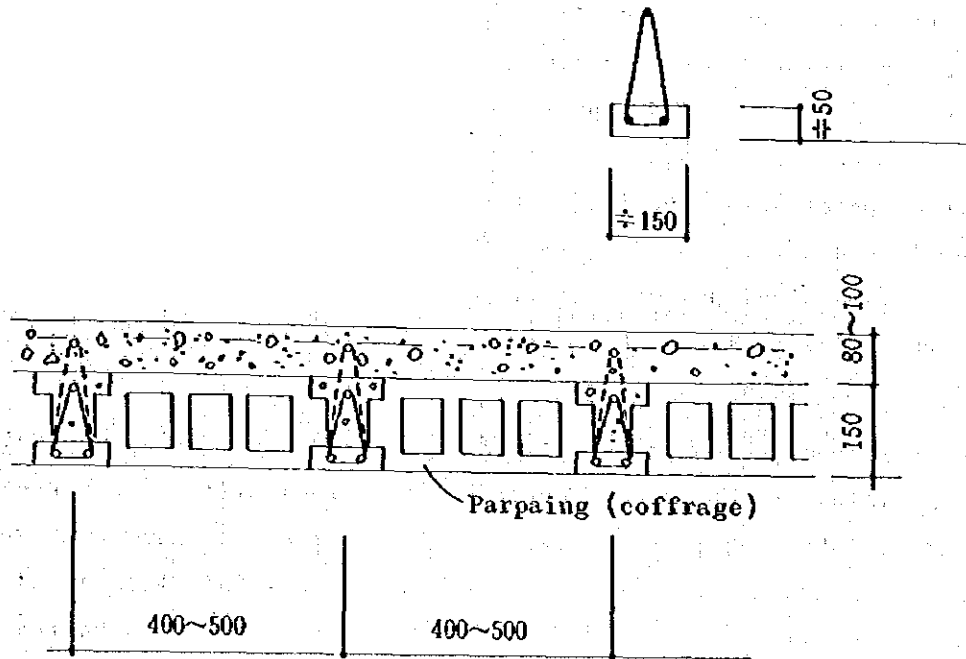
Méthode traditionnelle de construction de semelles utilisant des poutrelles préfabriquées
